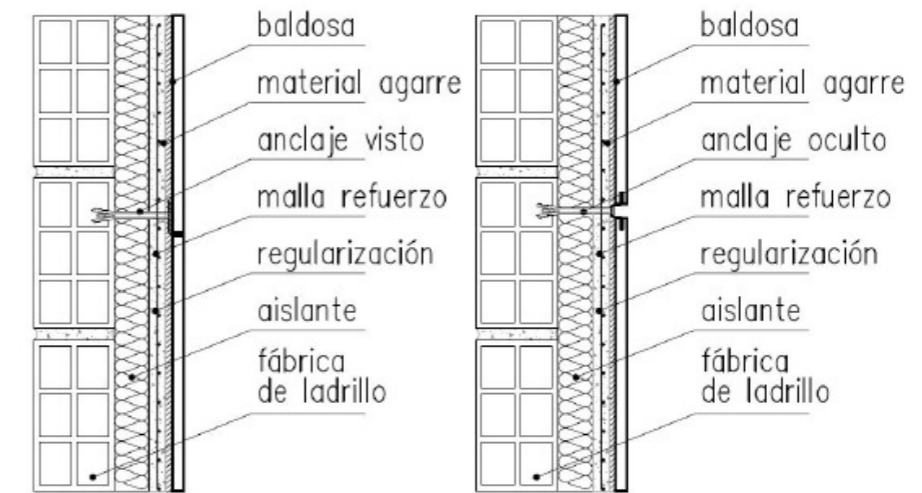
Detalle sistema mixto con anclaje mecánico R2m
